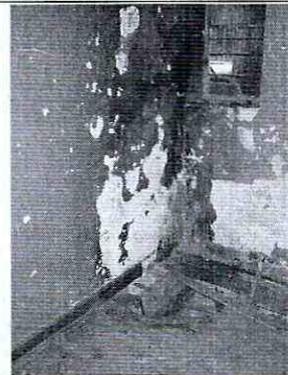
Segundo piso. Rompimiento elementos de entrepiso
